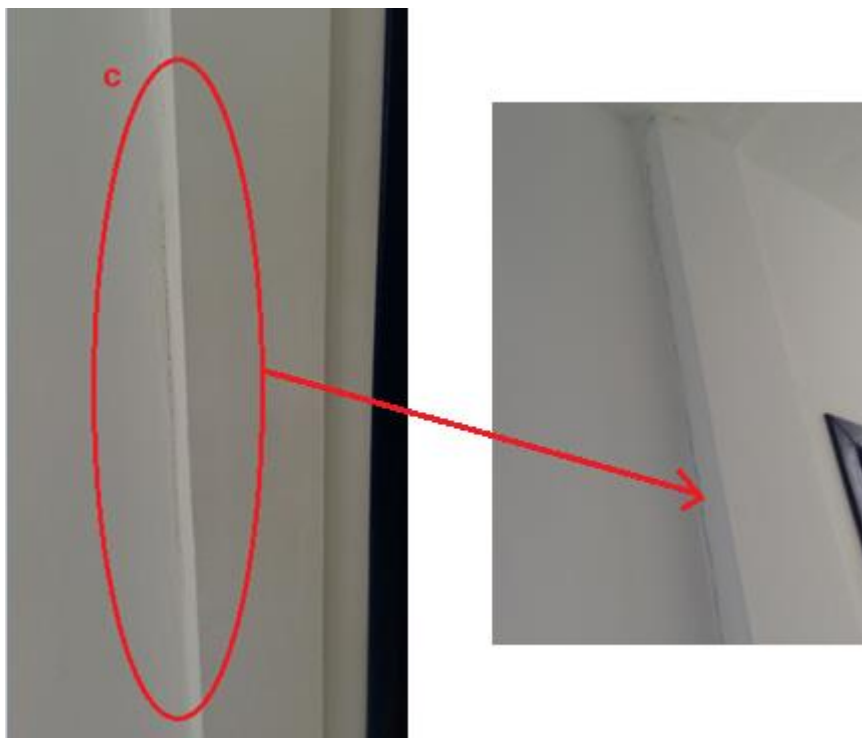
Ampliação da fissura com destacamento de argamassa
